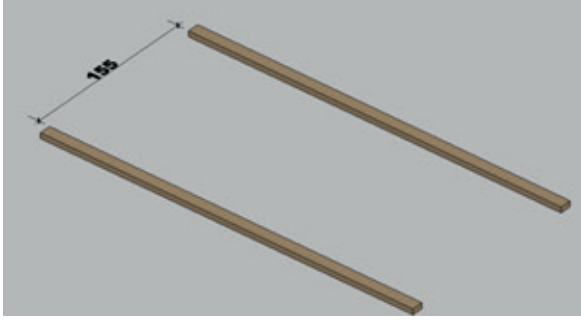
a: Birleşik temel planı ve kalıbı
